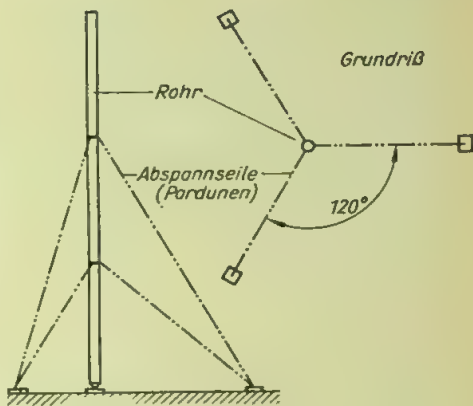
Abgespannter Stahlrohrmast
